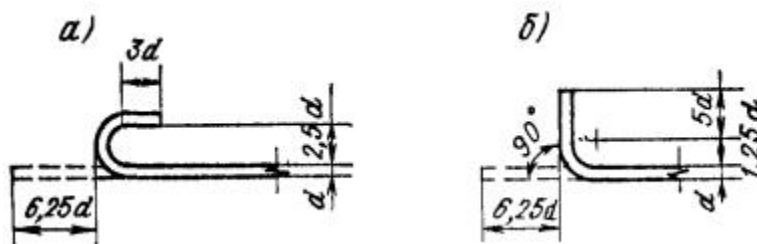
Размеры крюков (а) и лапок (б) на концах гладких стержней рабочей арматуры
